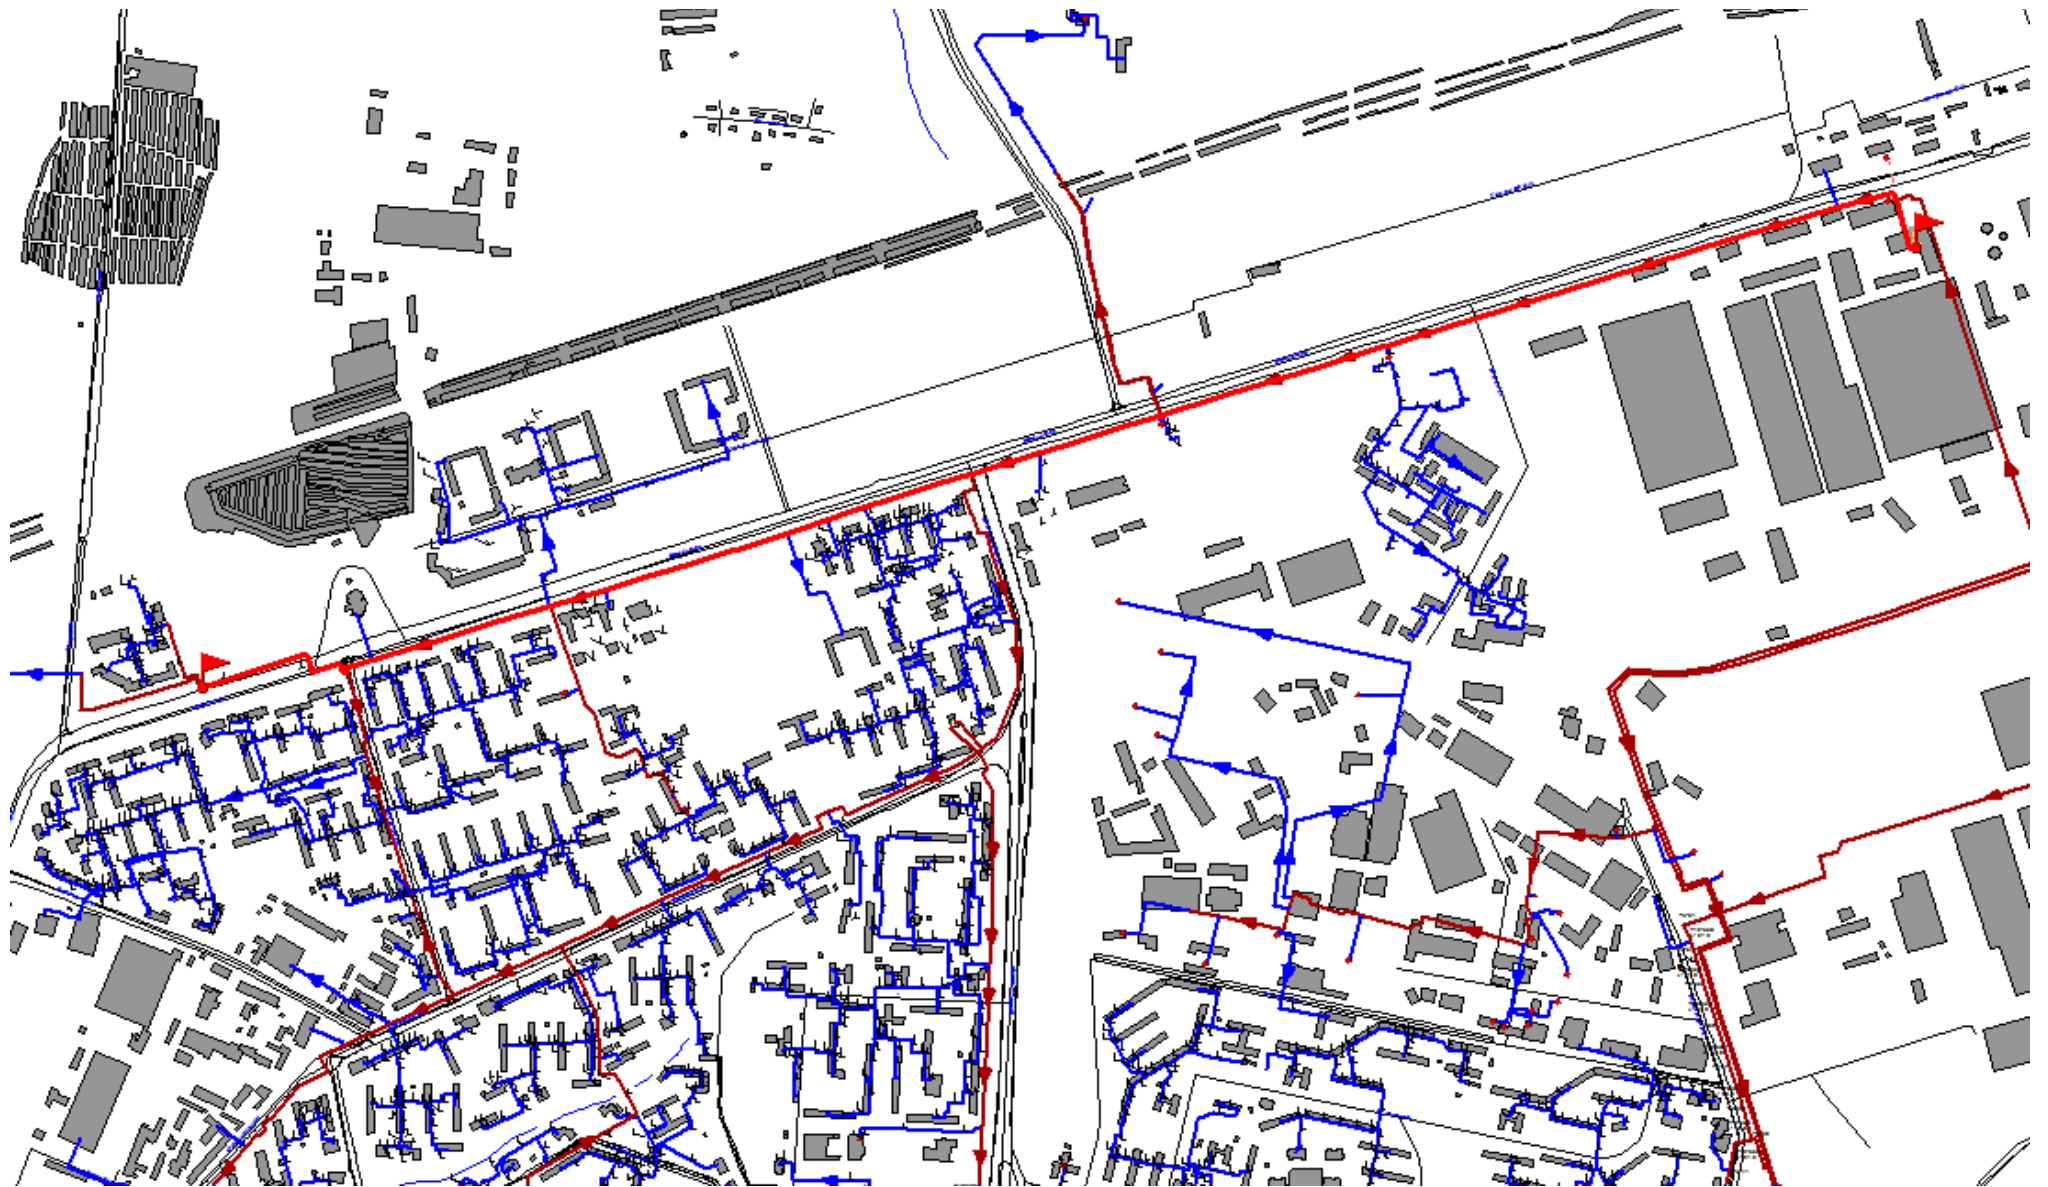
Расчетная схема участка тепловой сети от котельной ОАО «Ижметмаш» до ТК-2131/4
